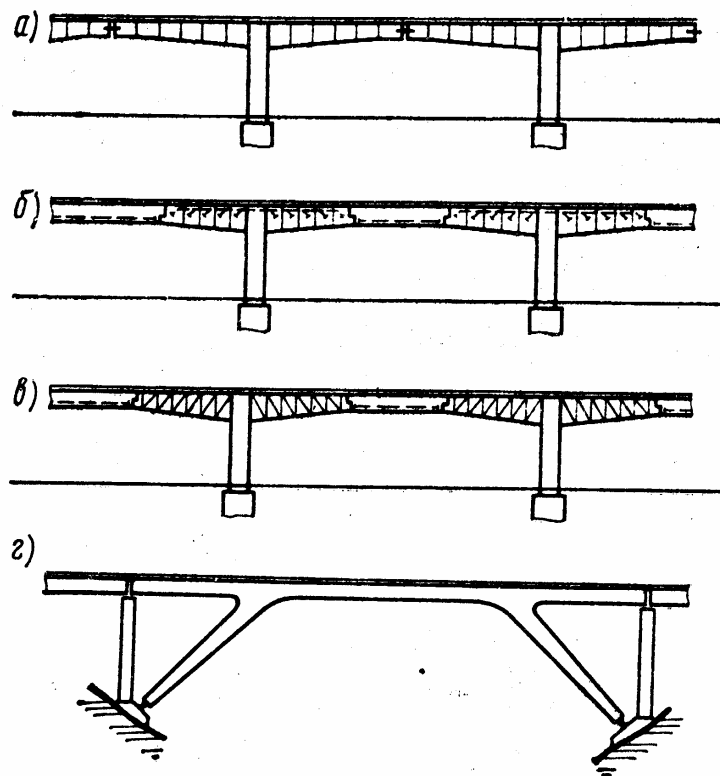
Схемы рамных мостов из предварительно напряженного железобетона
